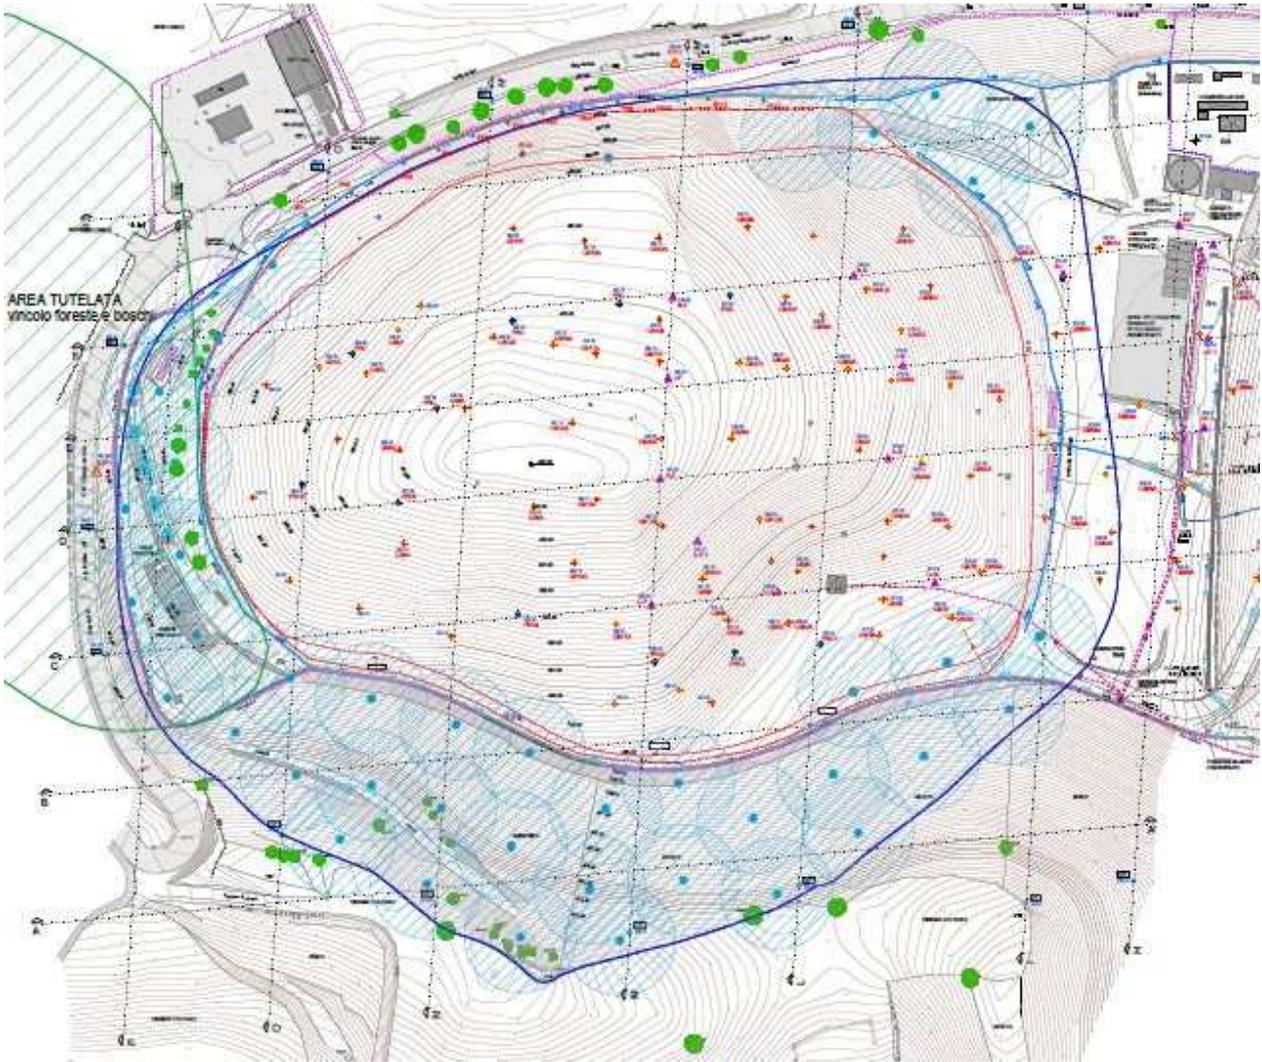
planimetria con indicati anche i pozzi già in autorizzazione ma che non sono più necessari.
